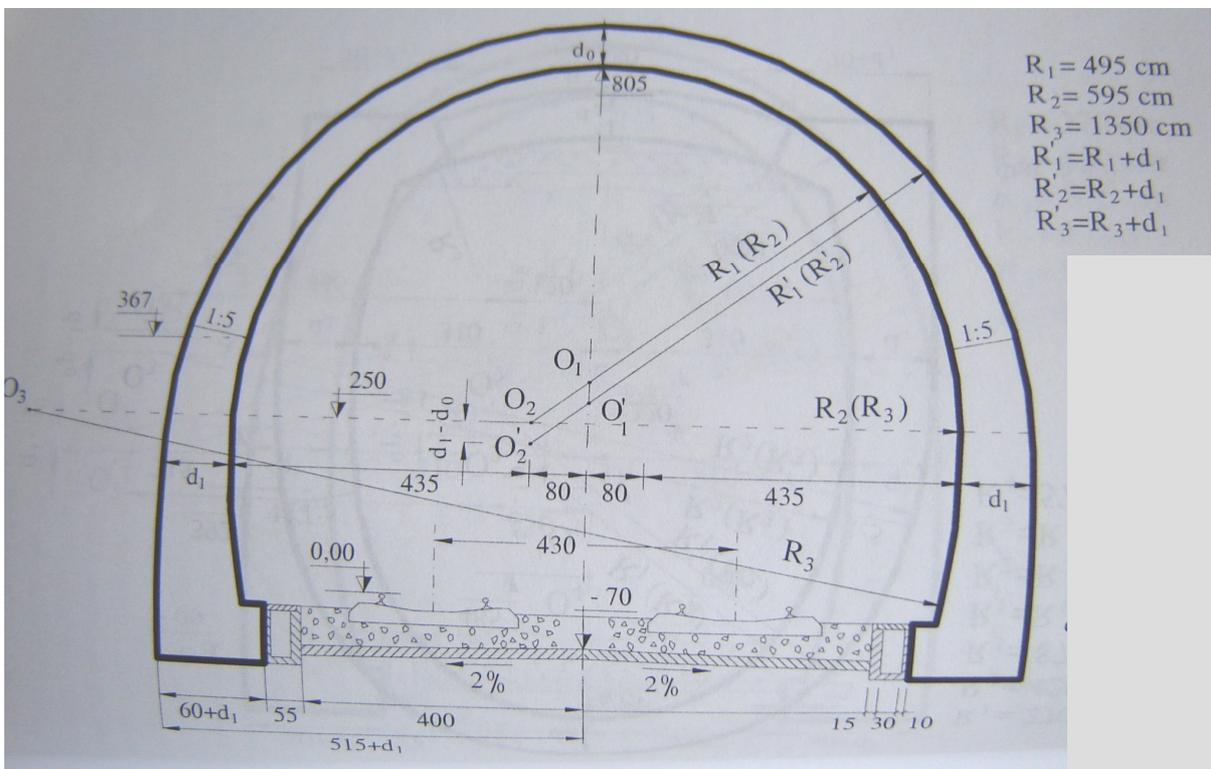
Typenprofil für zweispurigen Eisenbahntunnel
